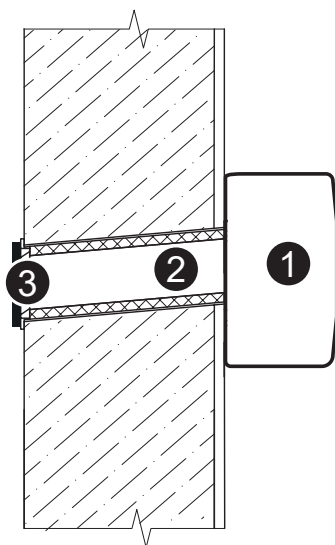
Крепление на железобетонные и кирпичные стены
